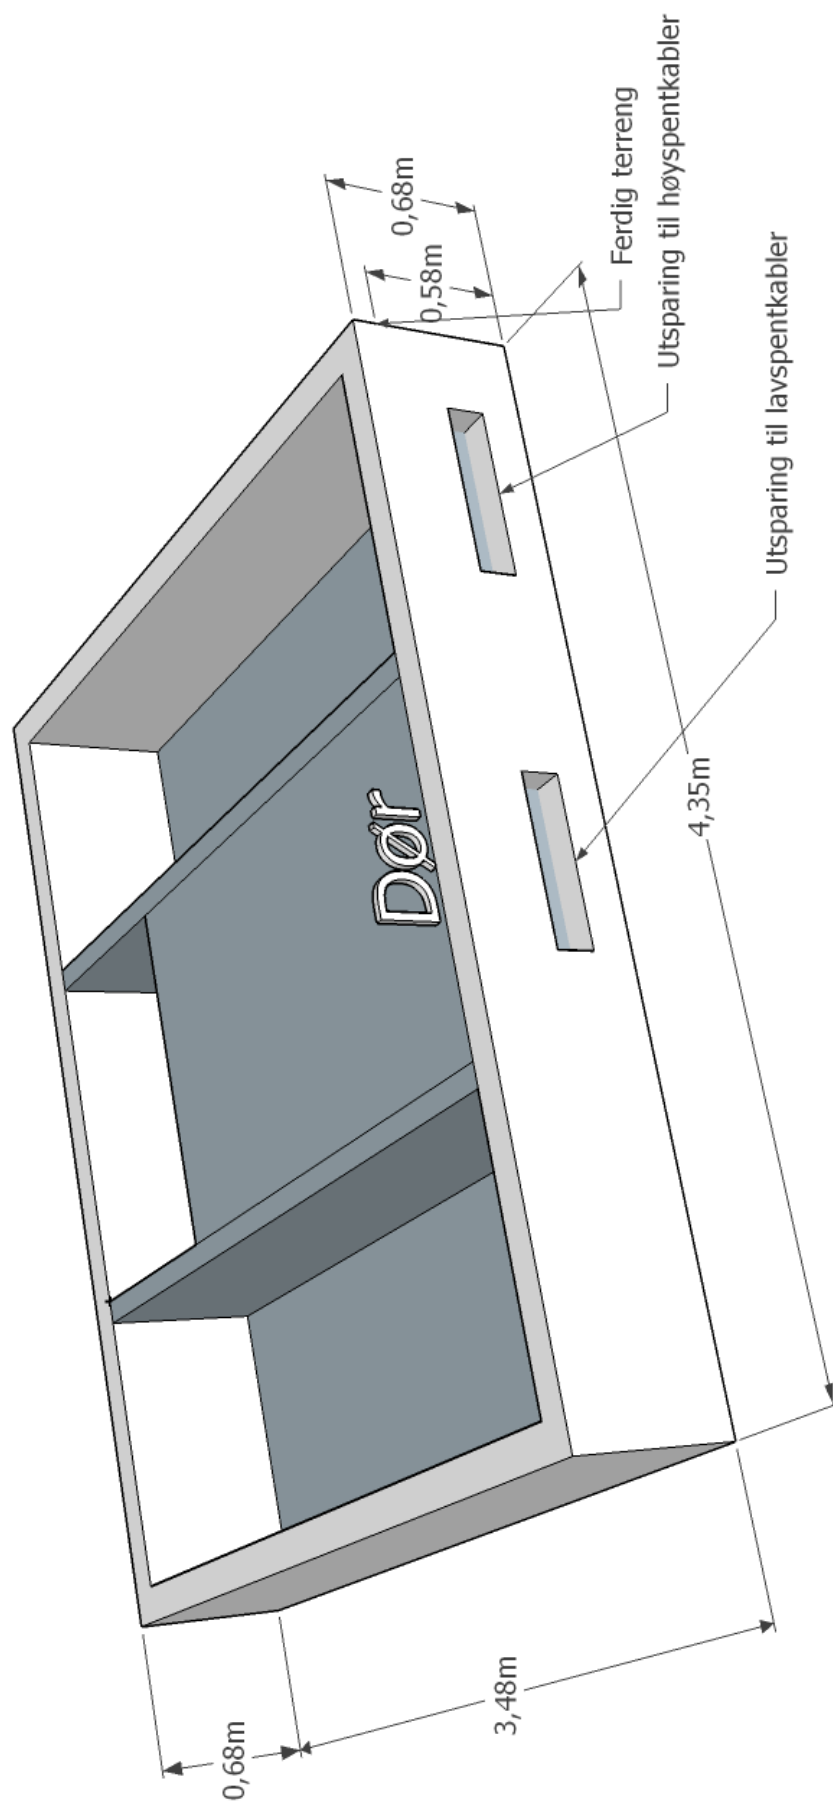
Skisse av fundament til prefabrikkert nettstasjon
